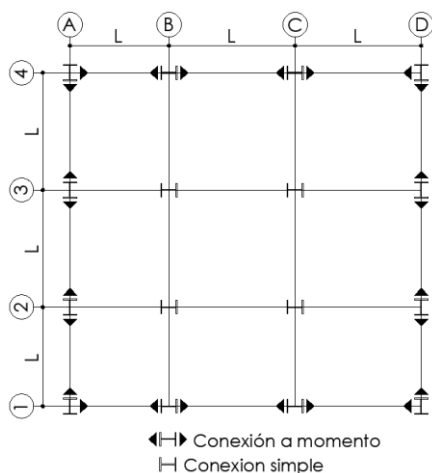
Planta genérica de edificio con pórticos de acero estructural.
